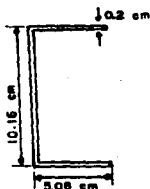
Corte transversal de las vigas de acero del soporte
